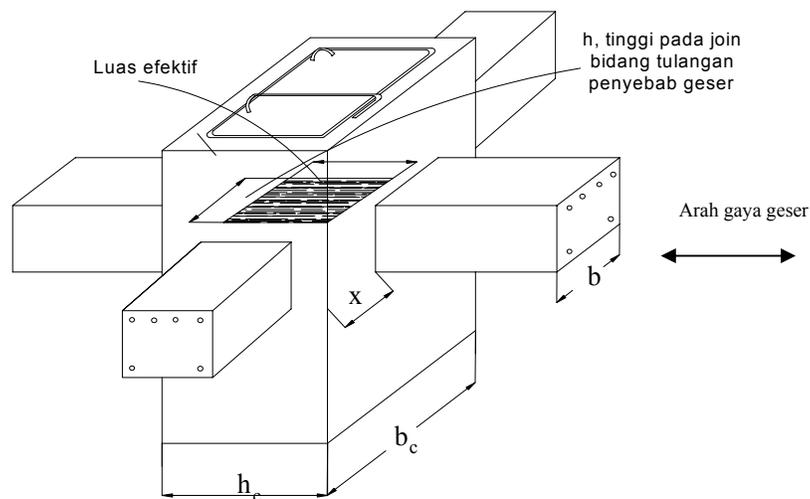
Tulangan transversal balok pada hubungan balok-kolom
